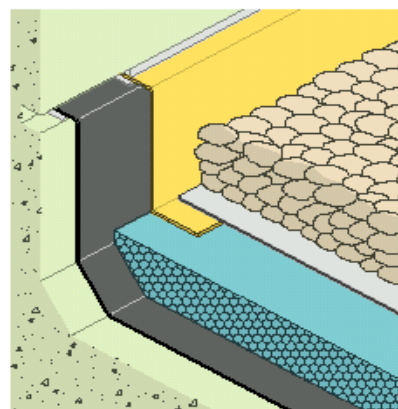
Ejemplo de unión con petos o paramentos. Instalación de planchas de XPS en cubierta plana invertida².
